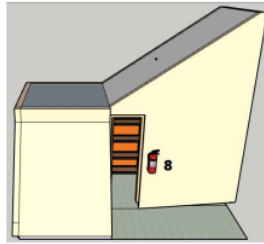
Desain baru 3D ruang filing 1 tampak depan
